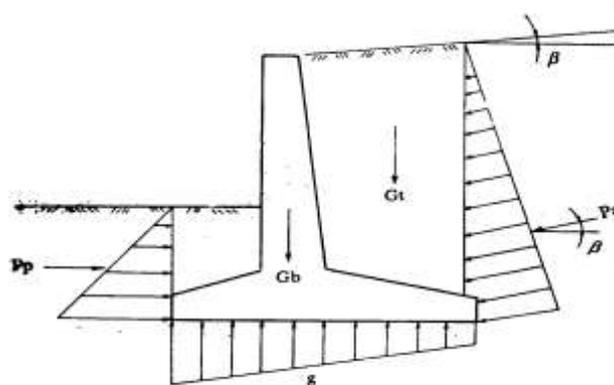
Pondasi Batu Kali Pada Batas Tanah
